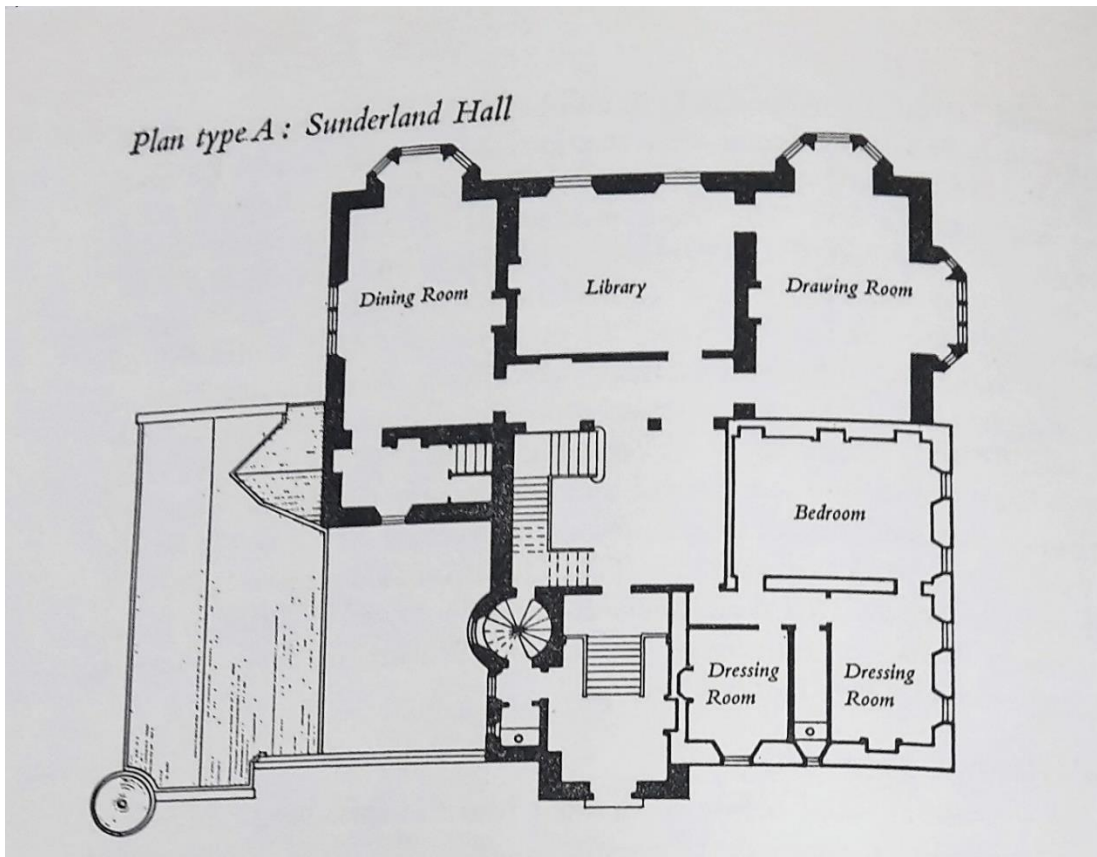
Plan de type A conçu par David Bryce : Sunderland Hall.
